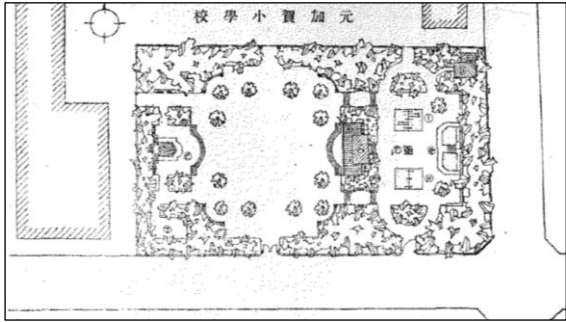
元加賀公園平面図(公財)東京都公園協会蔵
